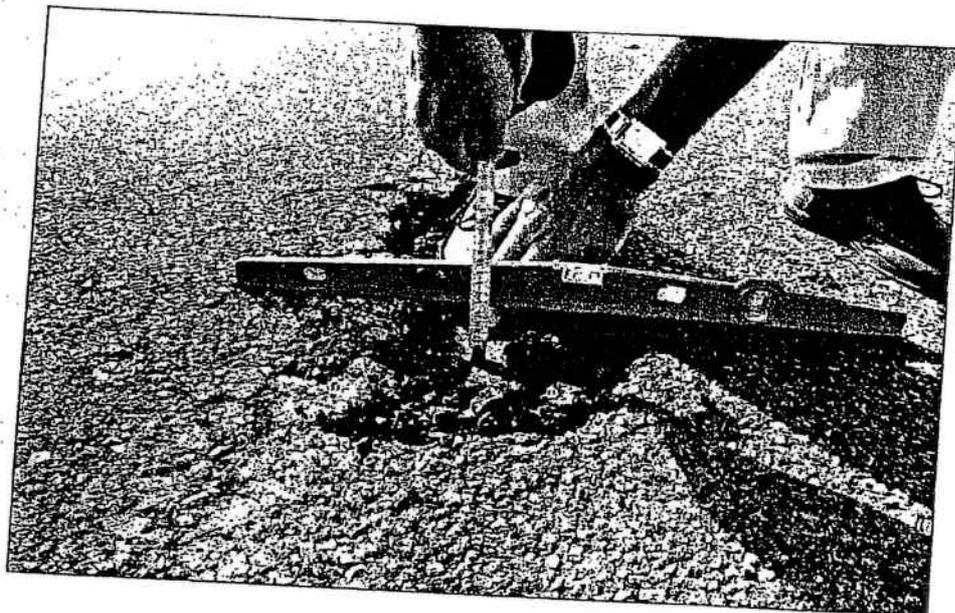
mesure épaisseur enrobé (5,5 cm) – axe chaussée.
